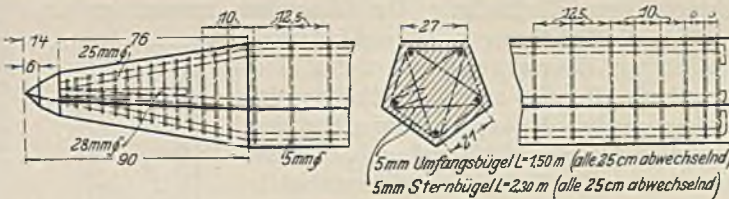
a u. 64 b. Anordnung der Bewehrung im Längs- und Querschnitt des Pfahles.
